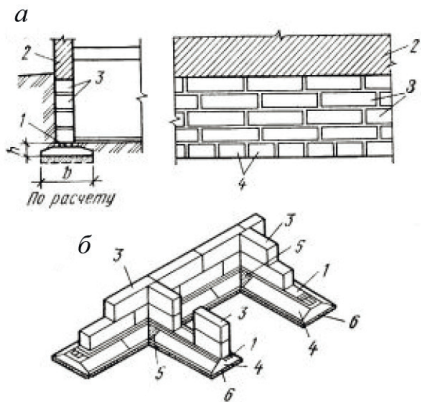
Стрічковий збірний фундамент із великих блоків:
